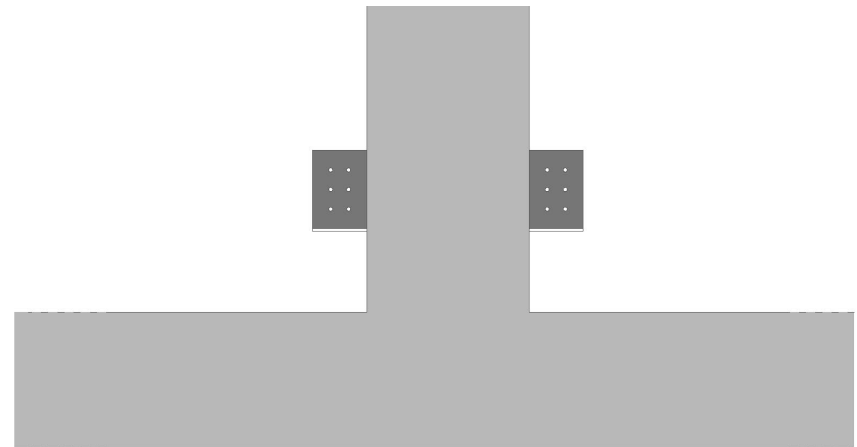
Carotaggio del pilastro sul lato corto e posa dei primi elementi di carpenteria
